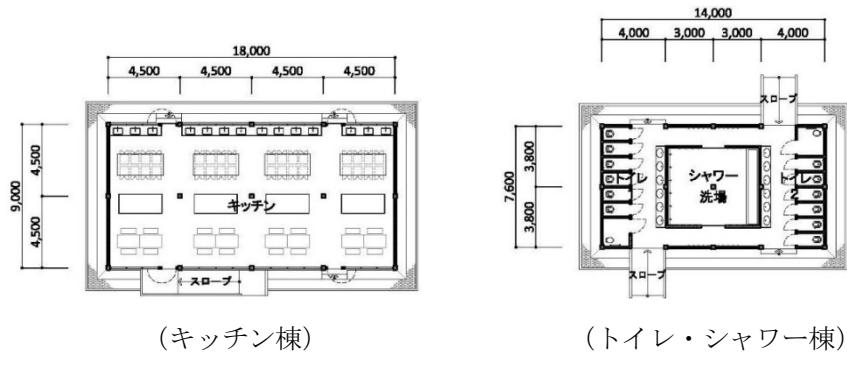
TTC 本体・学生寮用付帯施設平面図 (PKS TTC)
